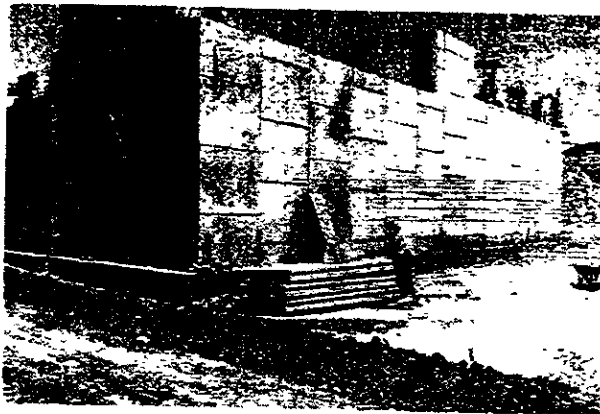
Detalle del estribo en un puente resuelto con elementos prefabricados.
